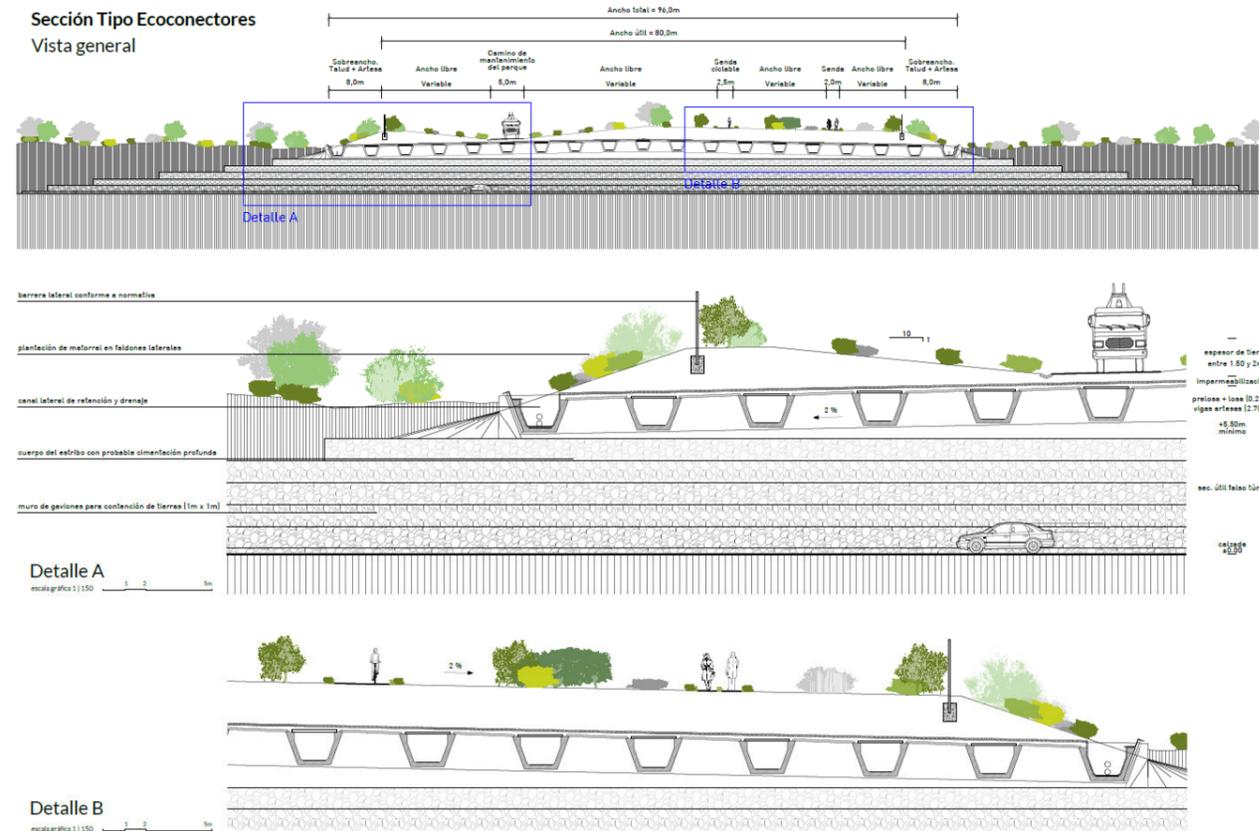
Sección tipo propuesta (predominante) de los Ecoconectores. Tablero de vigas artesas
